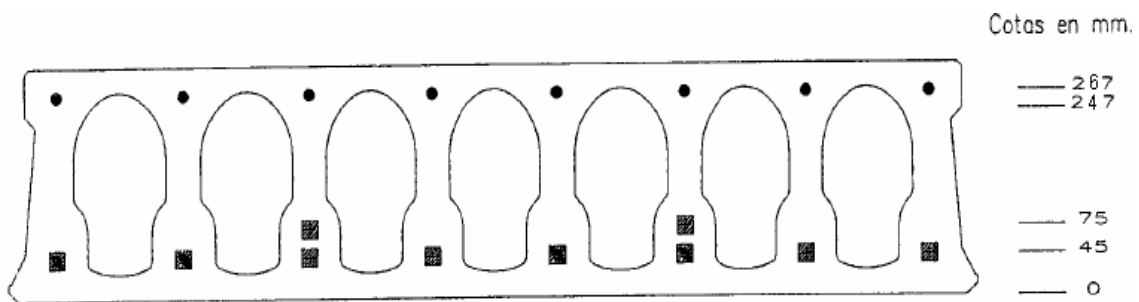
Situación de las armaduras en placa forjado 30.7
